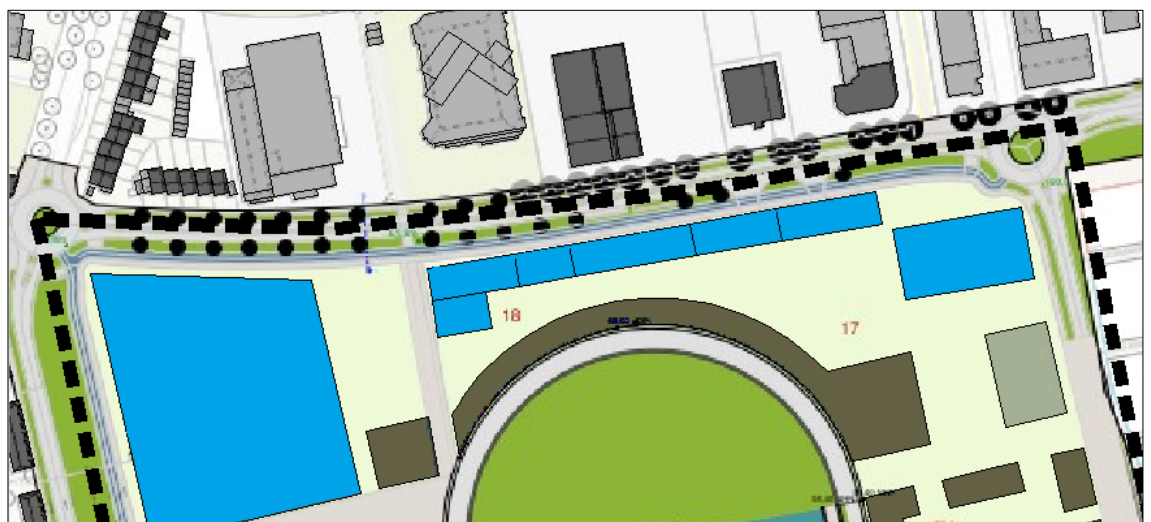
Plangebäude an der Blitzkuhlenstraße gem. Masterplanung (Stand März 2020)
